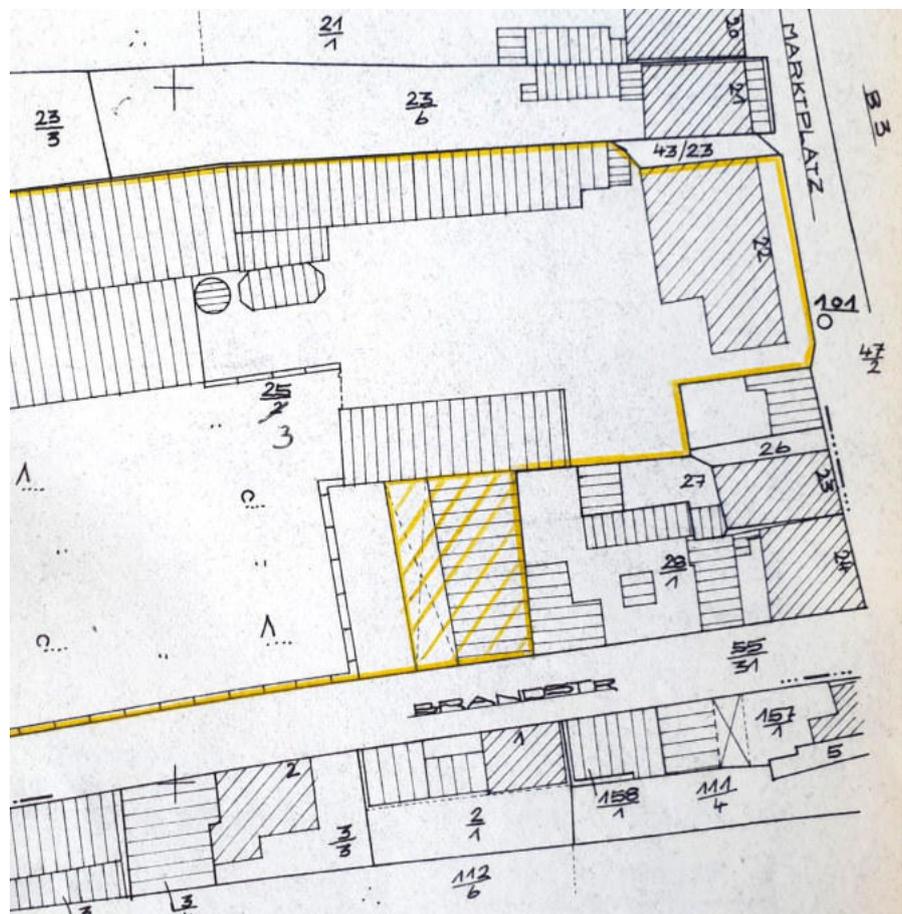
Lageplan der Bebauung im Bereich der heutigen Parzellen Hauptstraße 22 und Hauptstraße/Ecke Brandstraße. Die Zeichnung zeigt die ursprüngliche Zugehörigkeit des Wirtschaftsgebäudes und des Vorplatzes zu Hauptstraße 22. Die gelb schraffierten Bauten waren zum Abbruch vorgesehen (1977). Es handelte sich um eine weitere Fachwerkscheune mit Einfahrt am Giebel zur Brandstraße.
